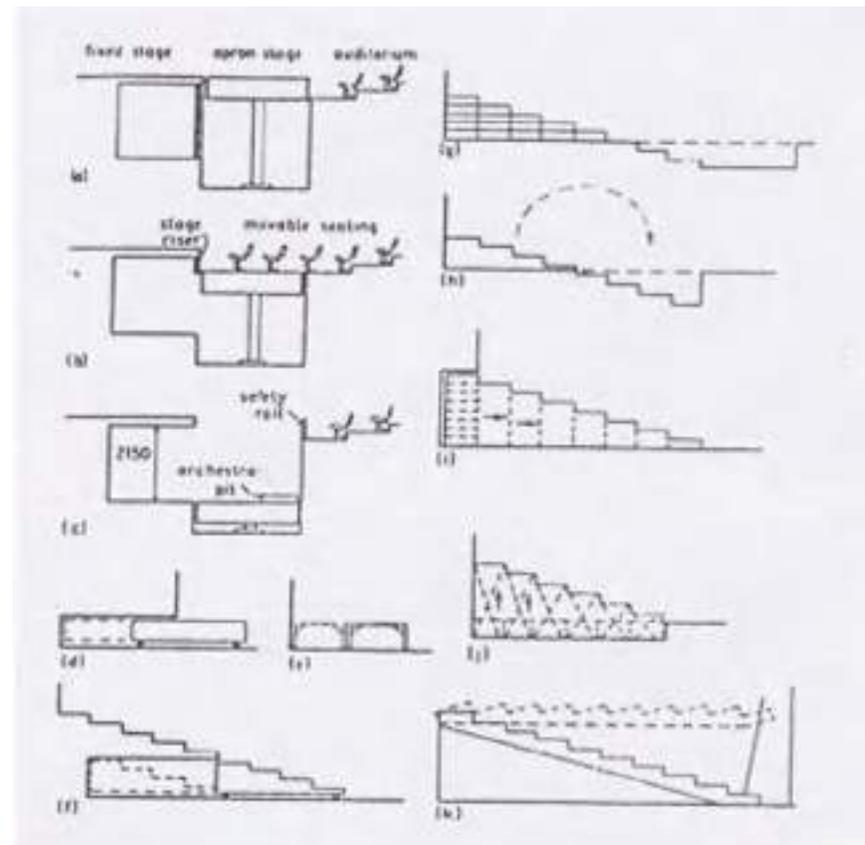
Skema Kontruksi Lantai Ruang Pertunjukan
